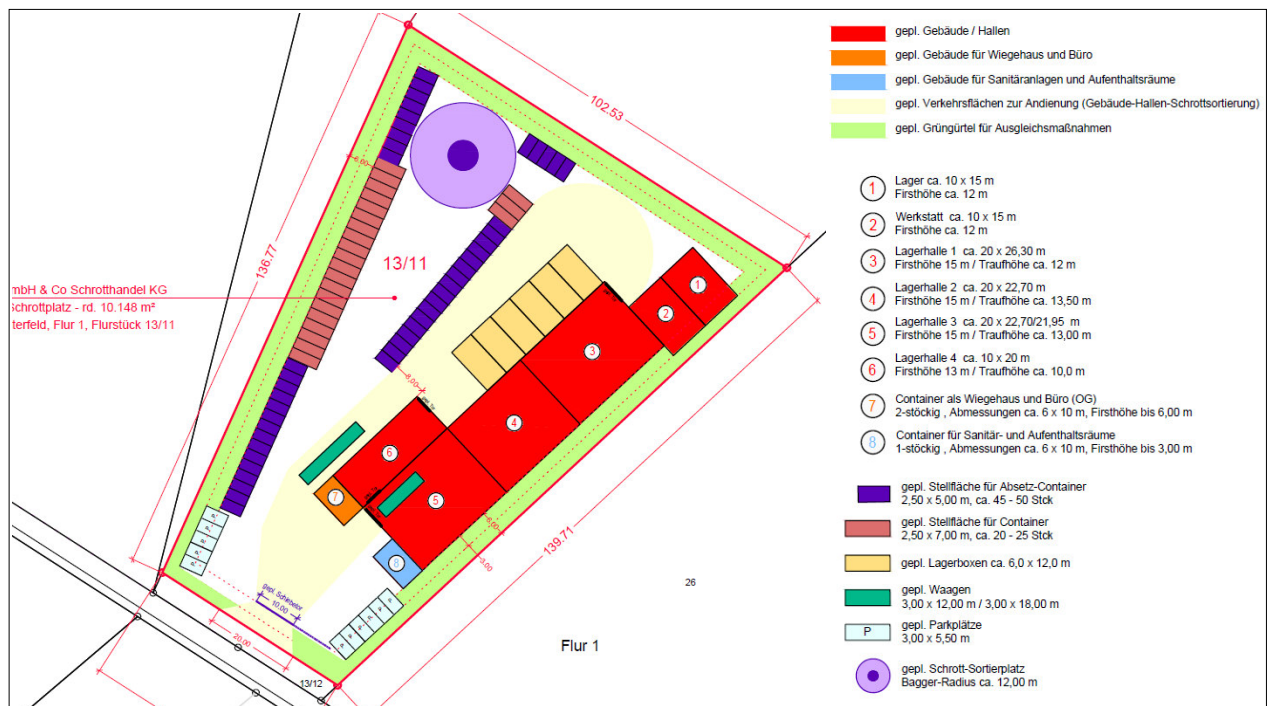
Untersuchter Baukörper (Gebäude/Hallen 1-6).
